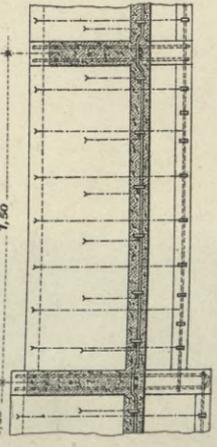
^b L-förmige Stützmauer aus Eisenbeton. M. 1:60.
